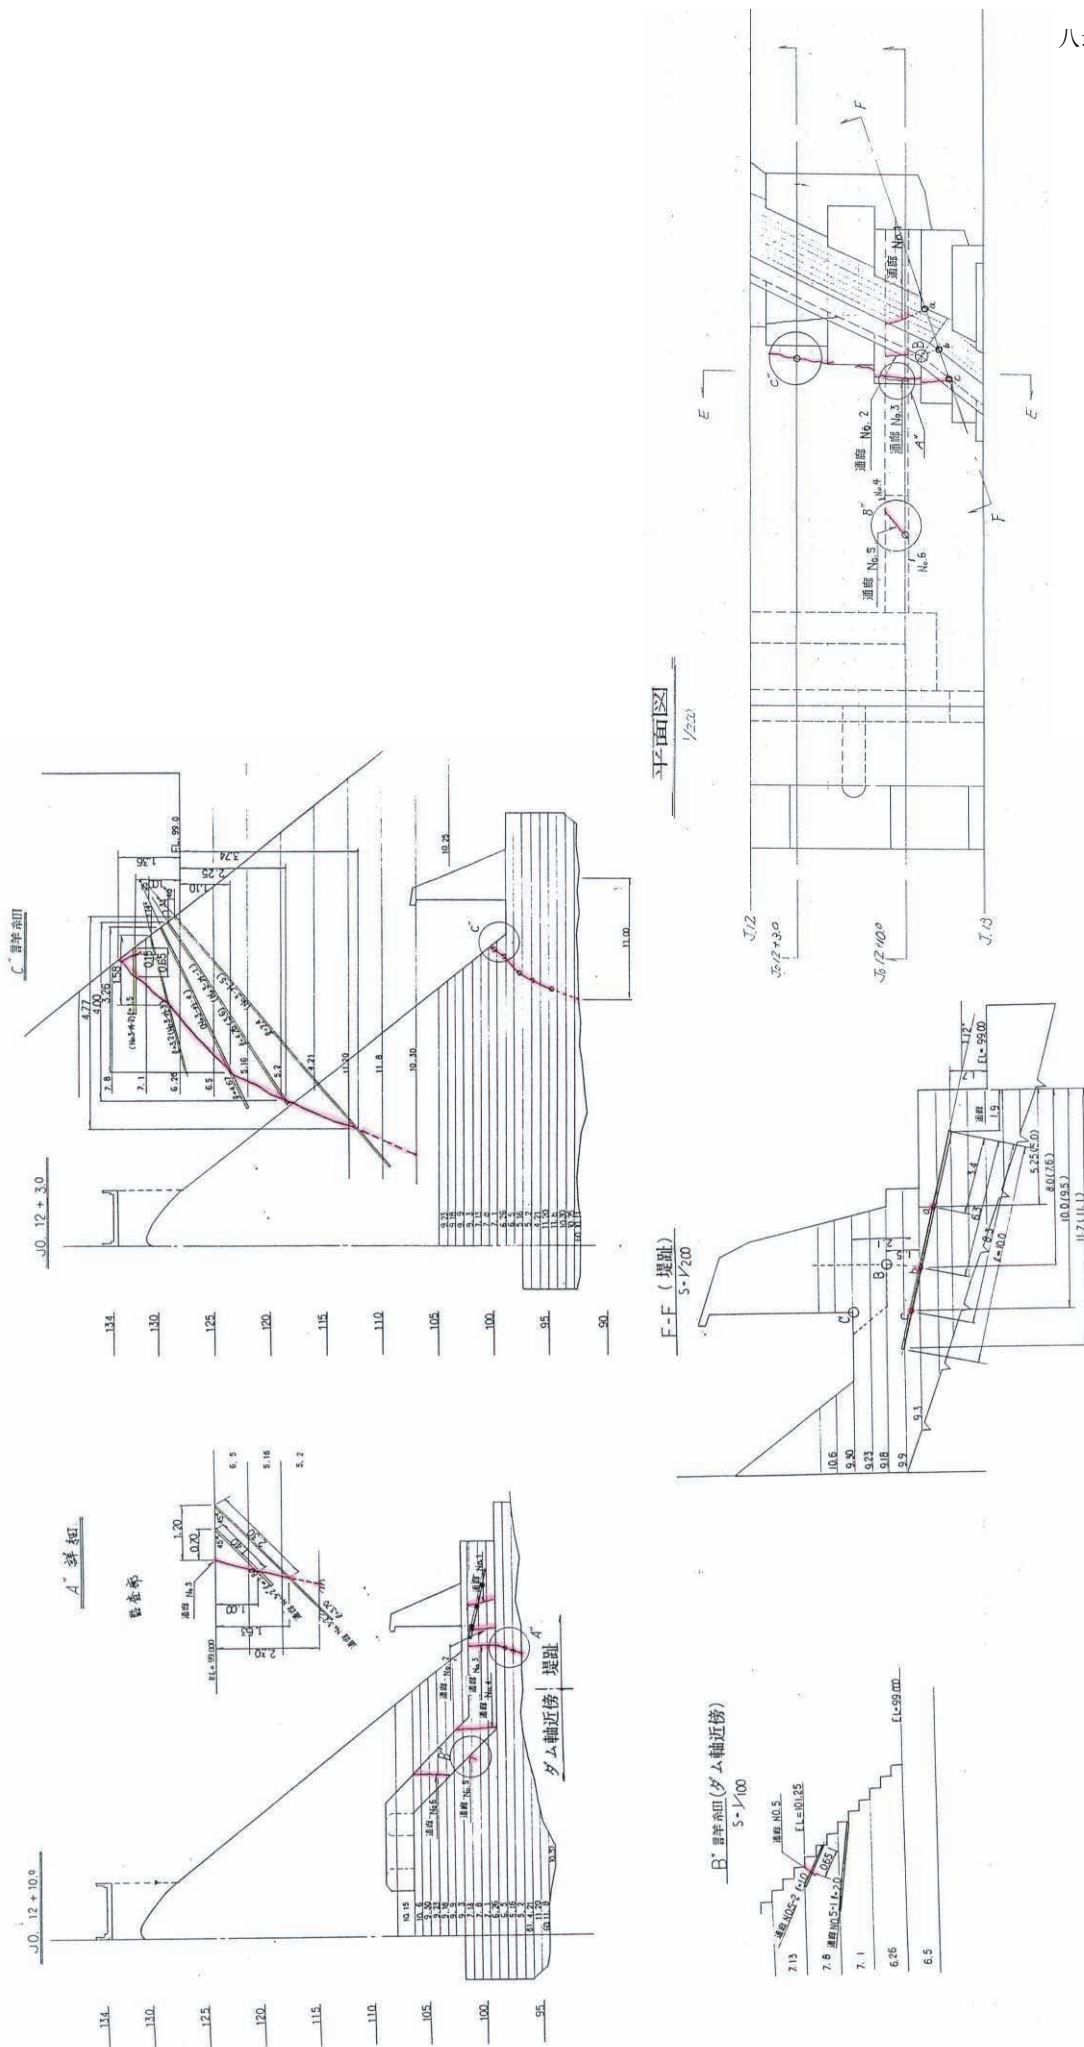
13BL ひび割れ追跡ボーリング位置図
